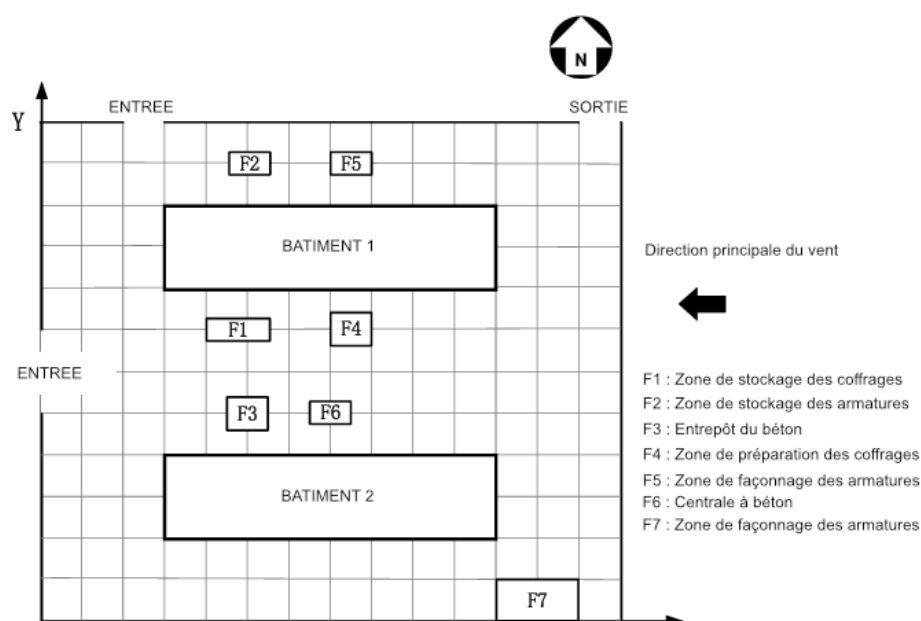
Plan de base d'implantation d'un chantier visant à réduire l'exposition aux poussières de construction.
